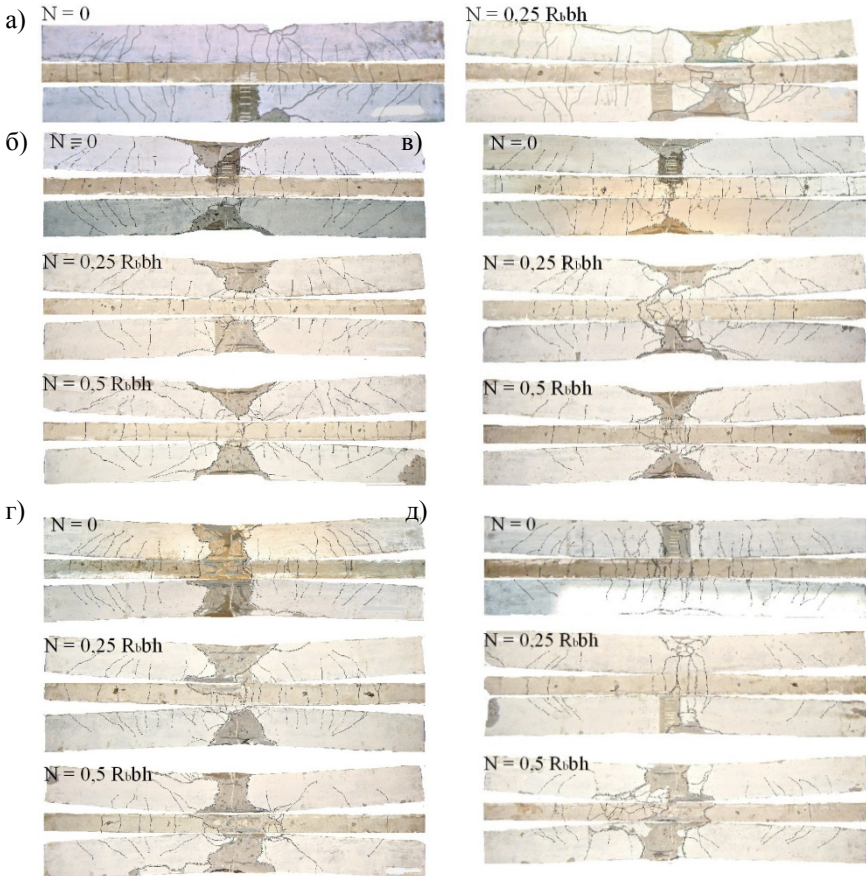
Схемы разрушения и трещинообразования балок: а) – железобетонная балка; б) – железобетонная балка с $\Delta f_{bt} = 40$ мм; в) – железобетонная балка с $\Delta f_{bt} = 60$ мм; г) – железобетонная балка с $\Delta f_b = 40$ мм; д) – железобетонная балка с $\Delta f_b = 60$ мм.
